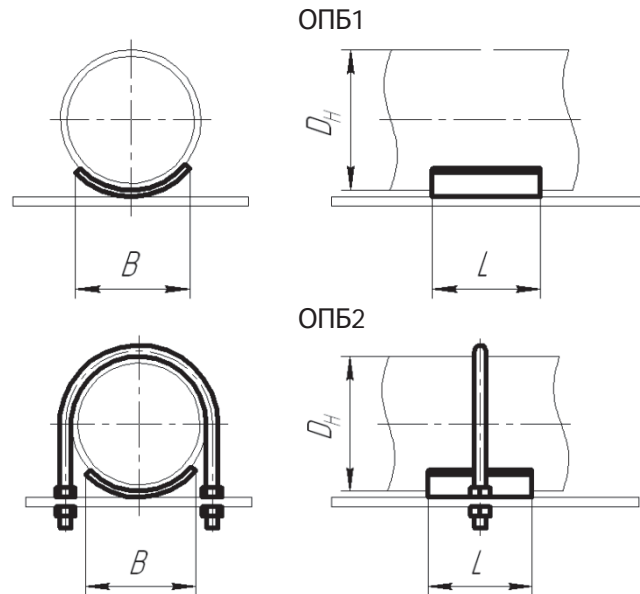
Опоры подвижные бескорпусные (ОПБ1 и ОПБ2)
